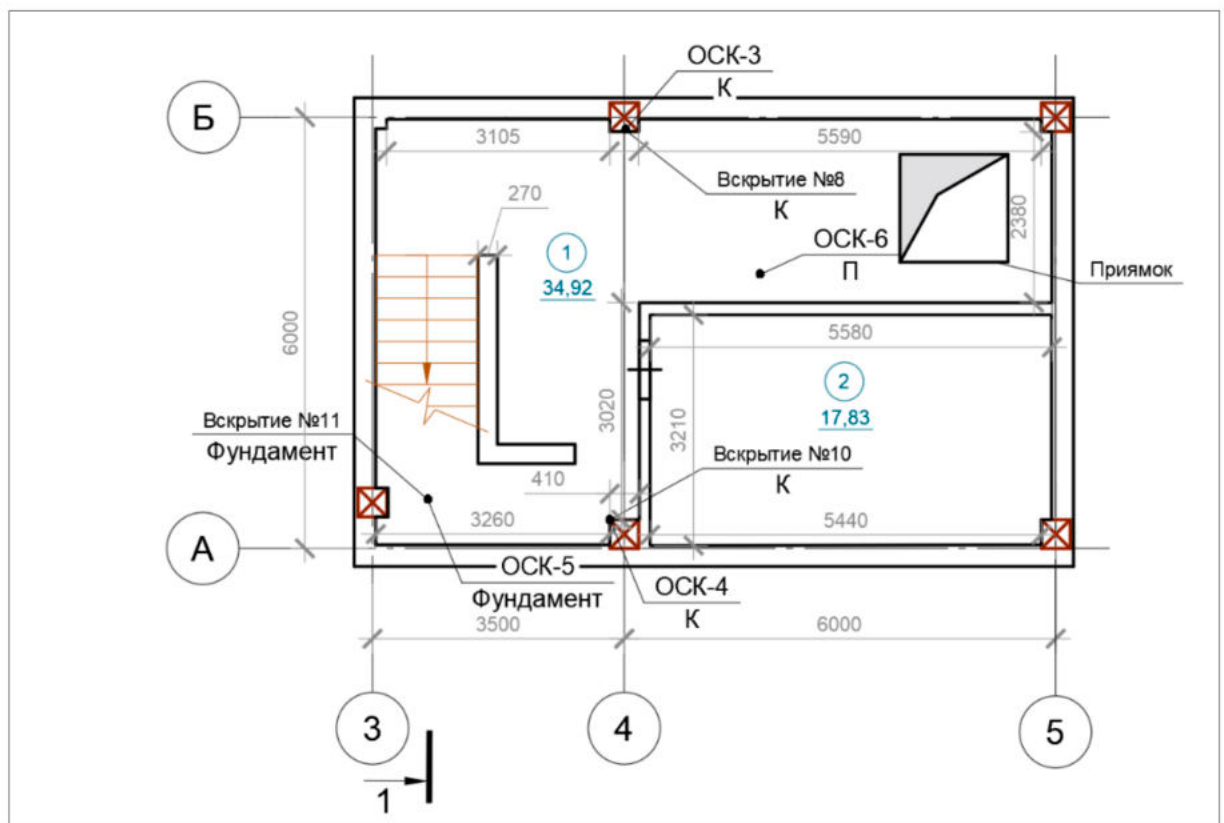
Фрагмент схемы расположения мест вскрытий и инструментальных исследований строительных конструкций.
